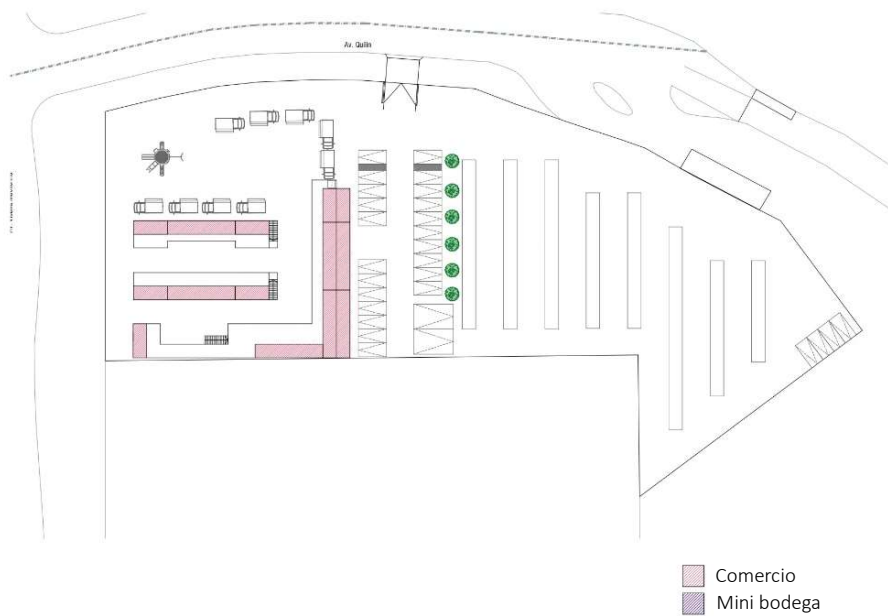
Planta 2° piso Fase 1. Fuente: Elaboración propia
